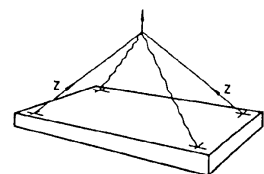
Statisch unbestimmte Aufhängung einer starren Last (2 Seilstränge tragen)
